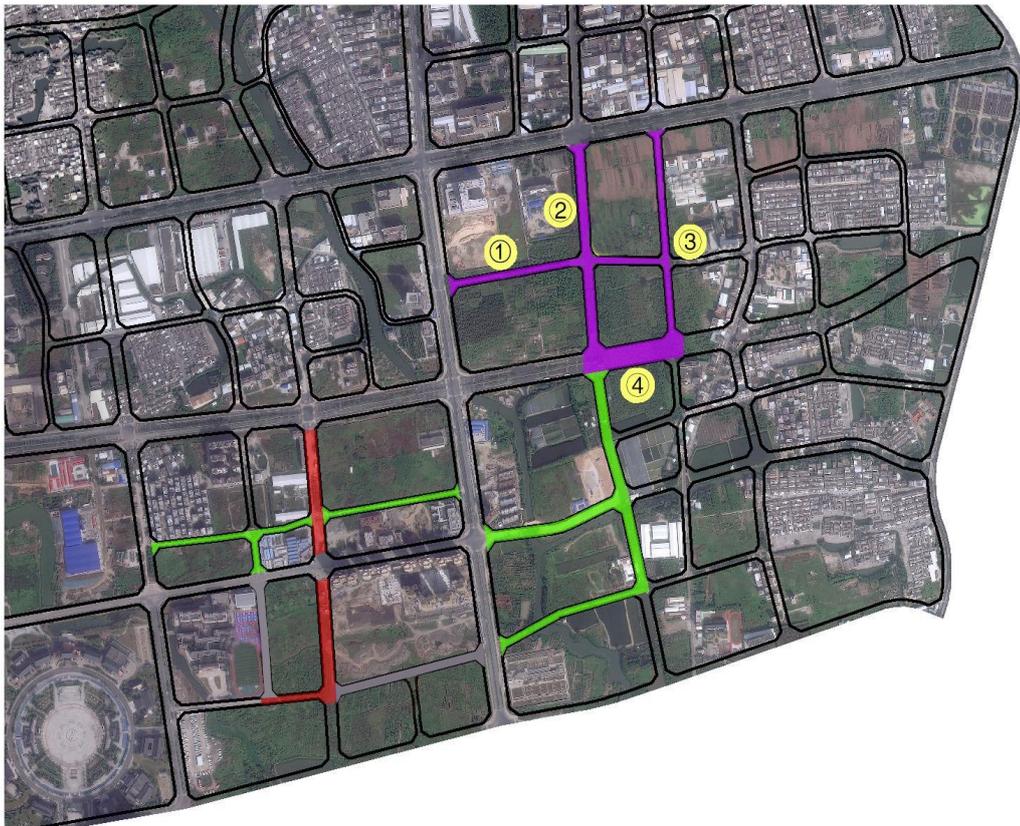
二期（榕江新城片区）配套建设道路设计平面图
